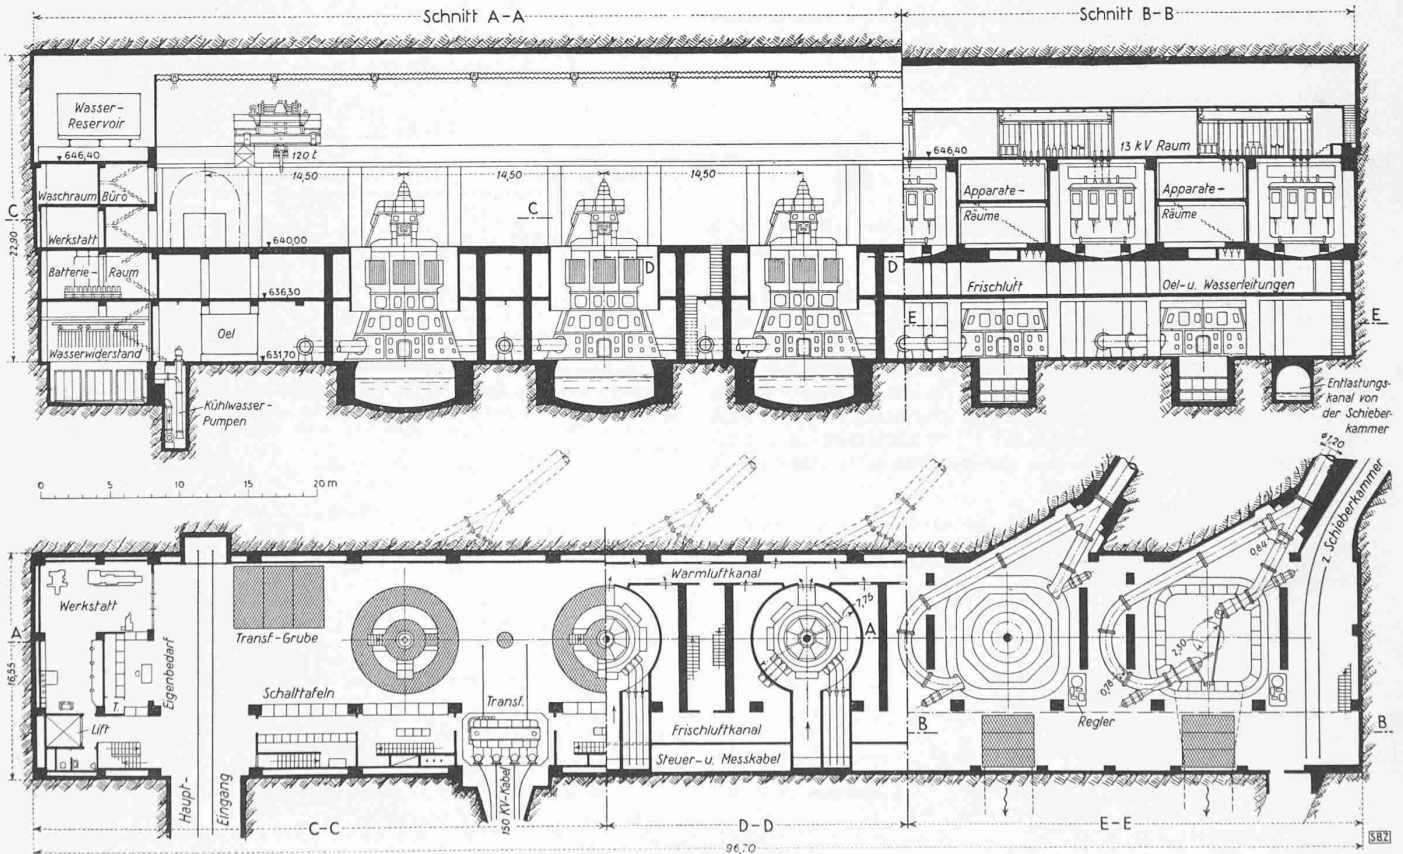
Zentrale Innertkirchen. Längsschnitt A-B und gestufter Grundriss C-D-E, Masstab 1 : 500
